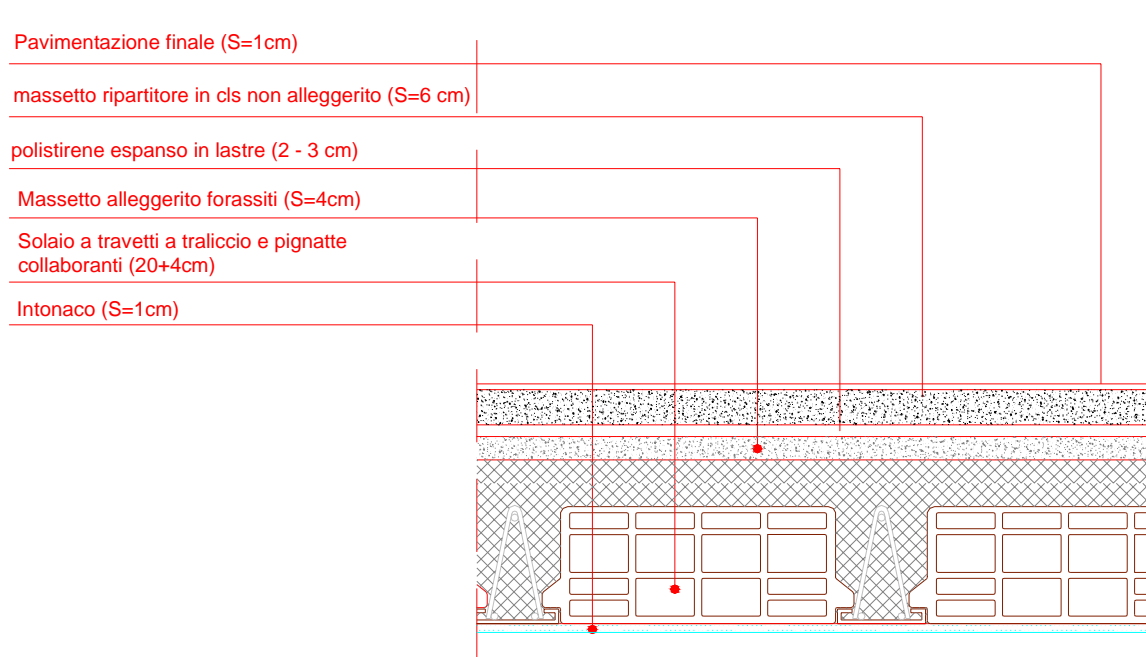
Disegno di dettaglio del solaio interpiano con pavimento galleggiante.
